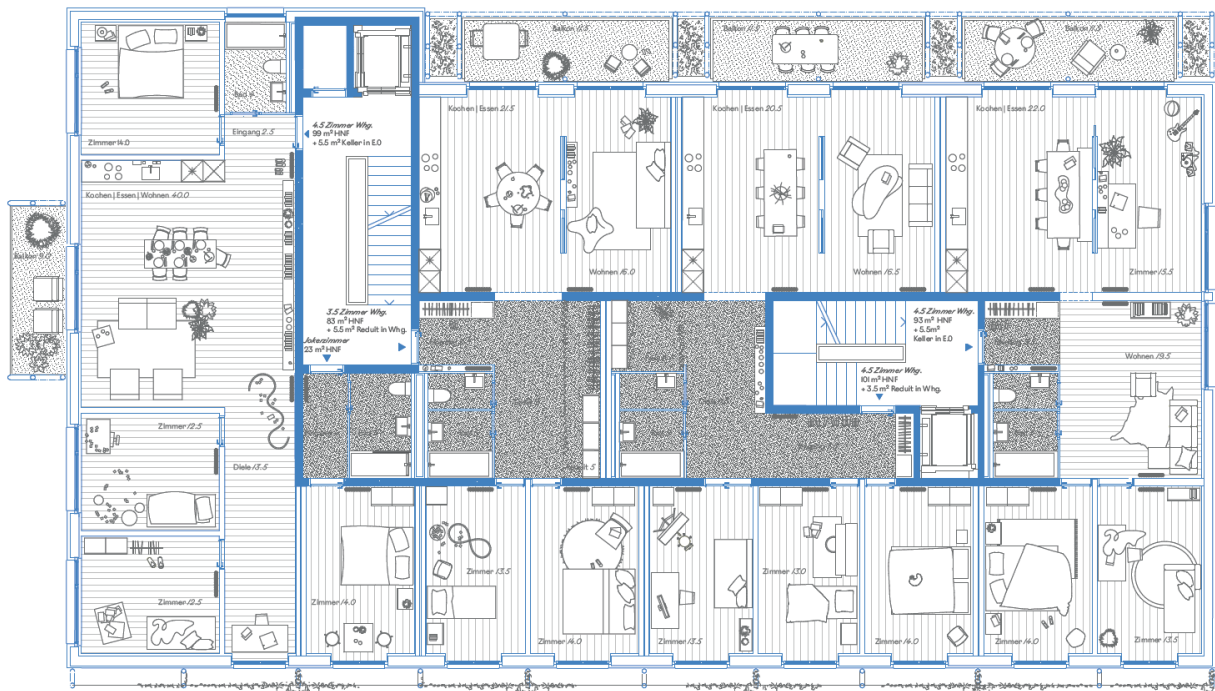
Grundriss Regelgeschoss, ohne Masstab
